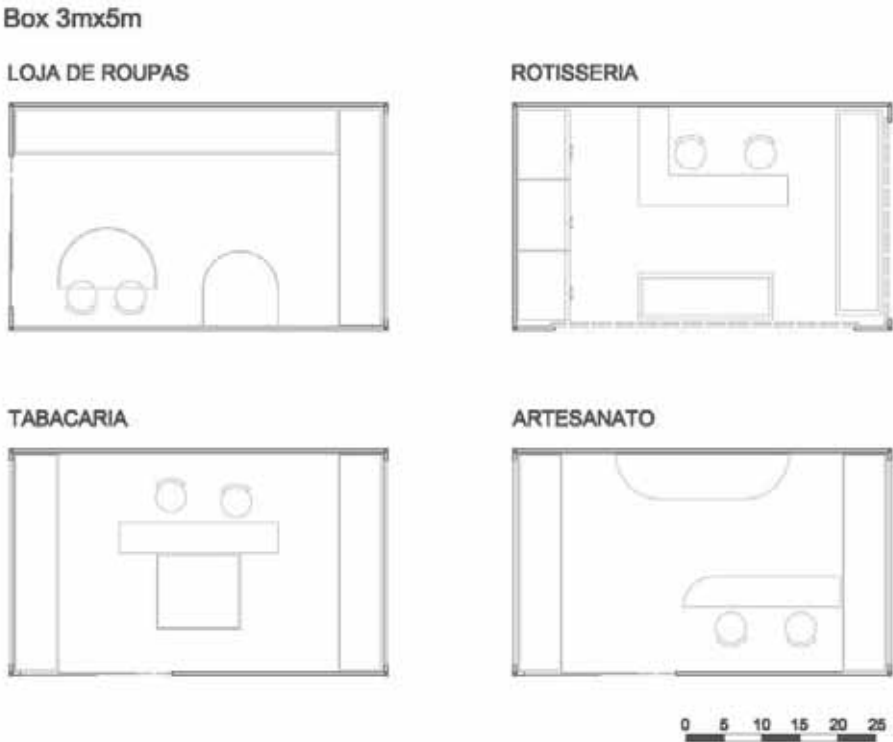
Boxes de 15m<sup>2</sup> - Layout
